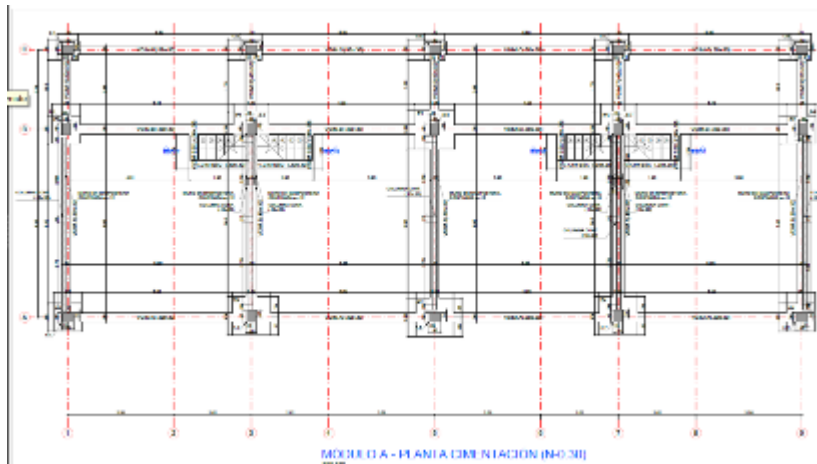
Cimentación para un módulo A compuesto por 4 casas.
